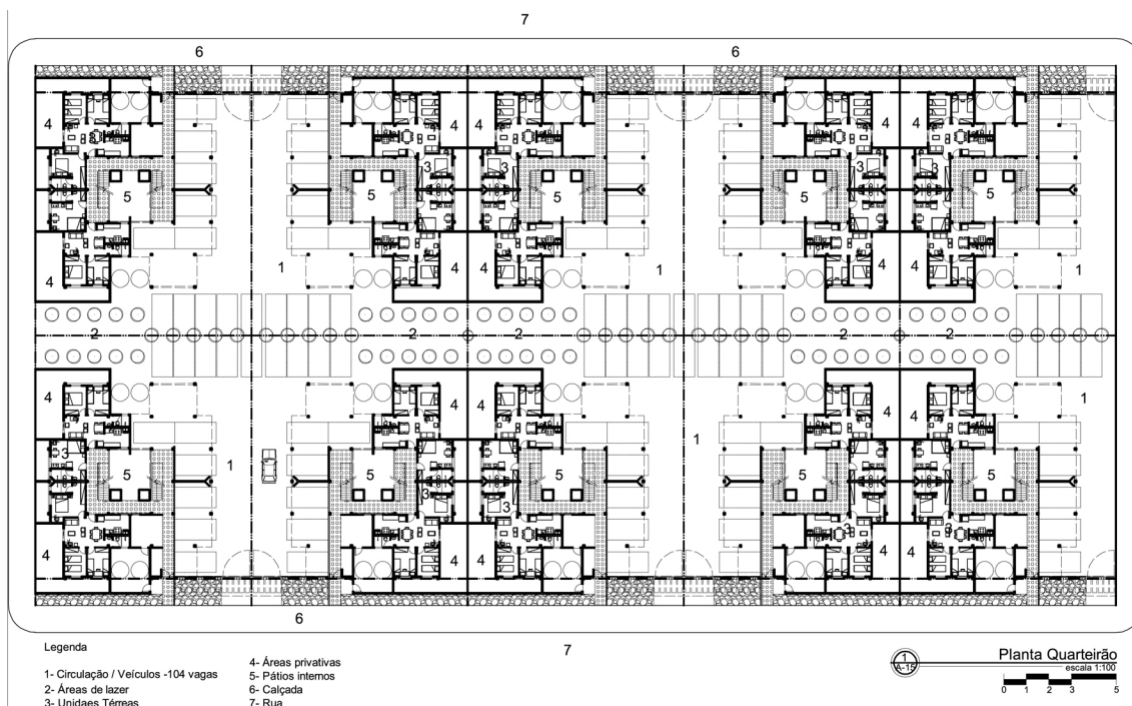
Planta quarteirão. Fonte: Arquivo do autor
